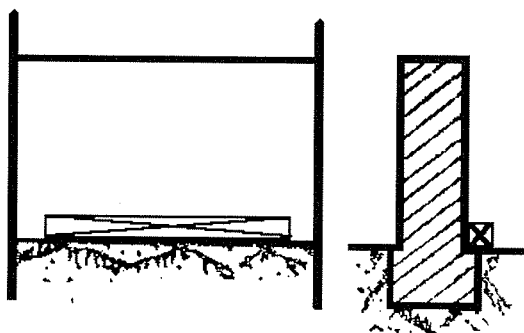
Carga alargada, con un muro de mampostería o ladrillo
